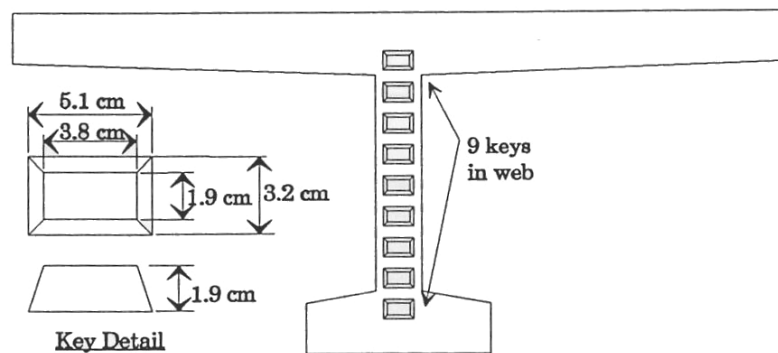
Sección transversal de la viga de Ramírez y detalle de las llaves conjugadas
